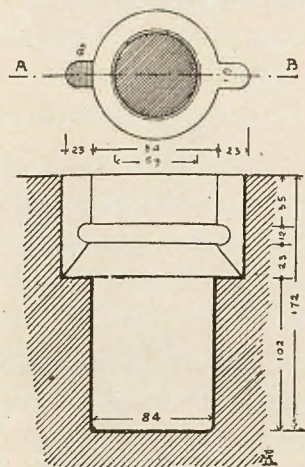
Plan et coupe suivant A B du logement du pivot de la porte. Sanctuaire d'Amenhotep I^{er}.
